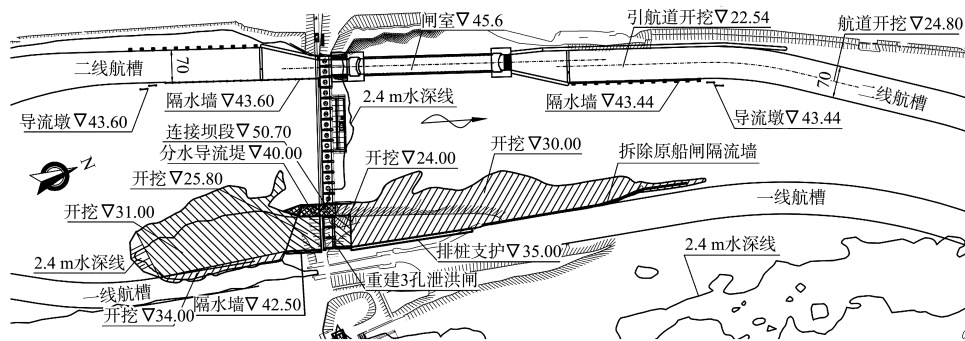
左岸新建船闸修改方案平面布置 (单位: m)
